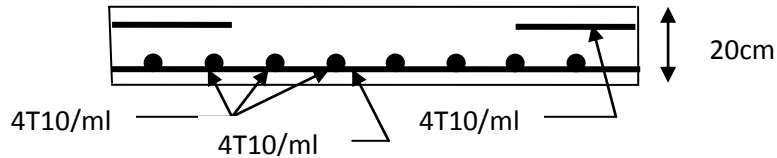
Coupe transversale la dalle de l'ascenseur
